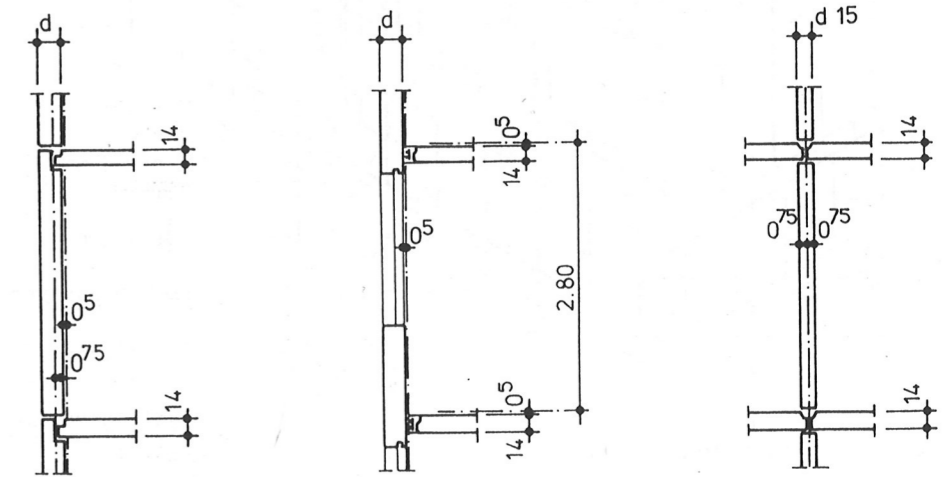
Systemlinienlage - Vertikalschnitt
